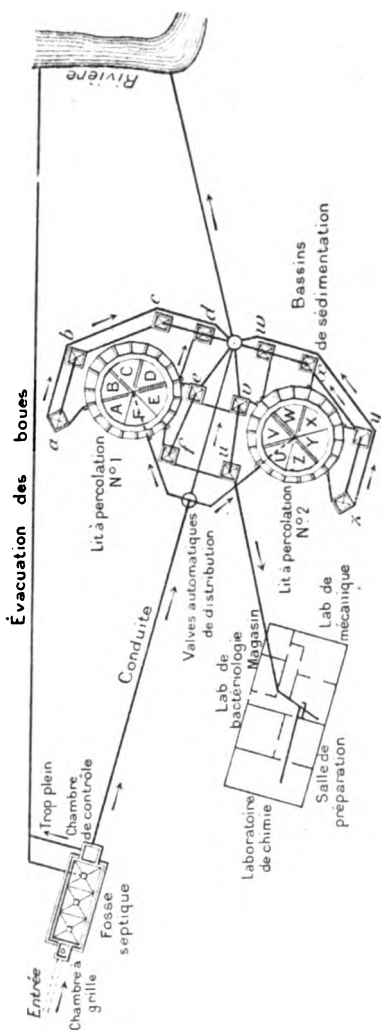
Plan de la station expérimentale d'épuration des eaux d'égout de *Baltimore*.
